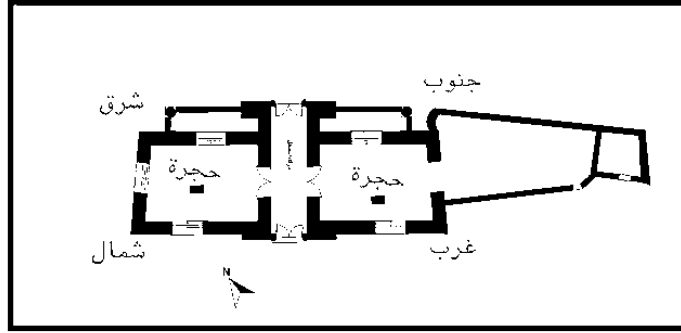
مسقط أفقي لمحمود نور الدين وعائلته .
